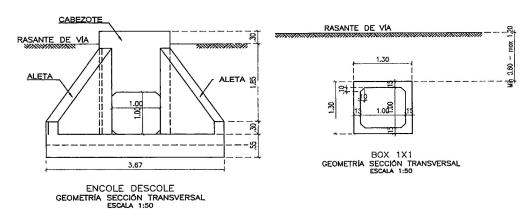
Detalle transversal del descole de box culvert de 1x111.
